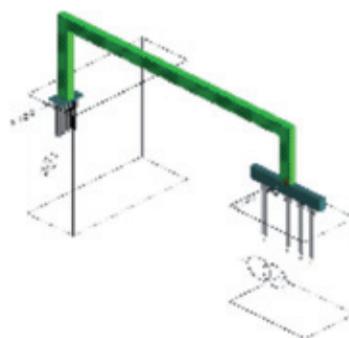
Collegamento di un quadro Power Center attraverso un condotto sbarre prefabbricato
